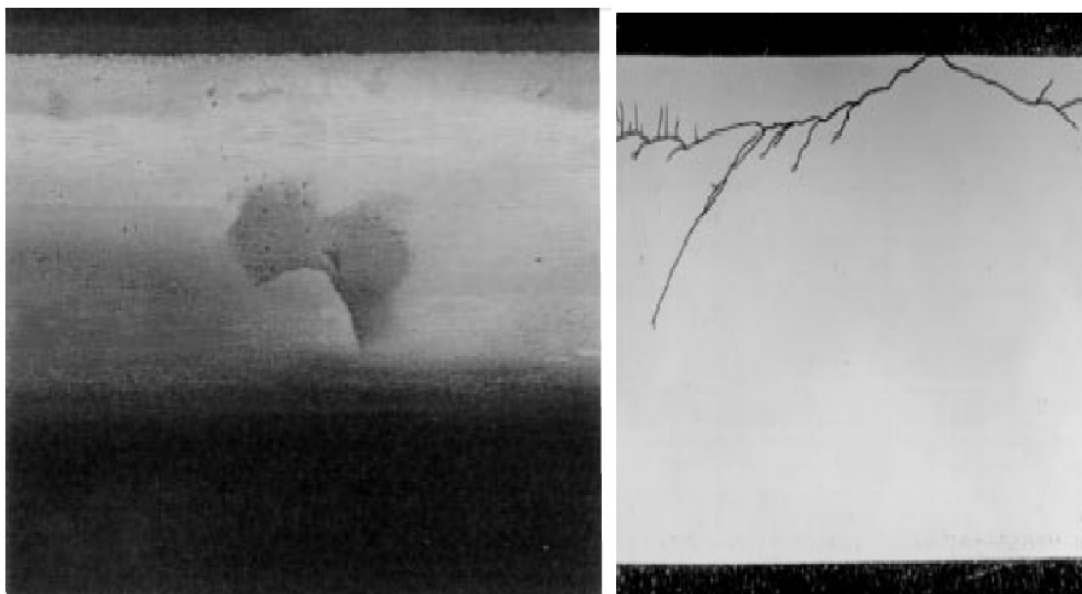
šikmé trhliny pojížděné hrany (head checking)
